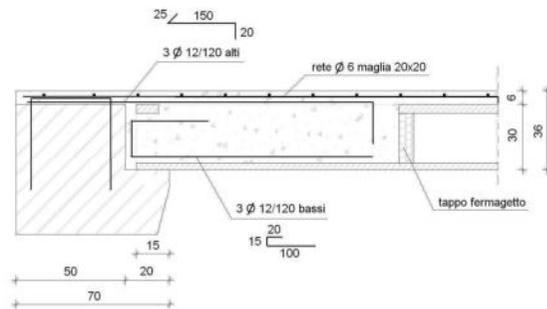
Esempio di collegamento con trave di bordo
